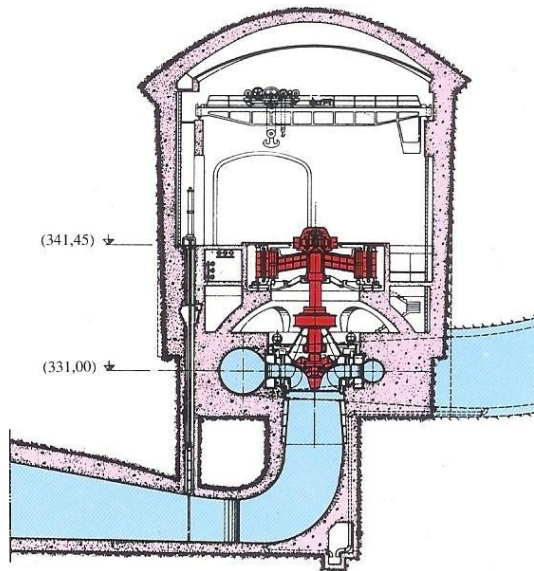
Corte transversal da central hidroeléctrica de aproveitamento de Bemposta; [3]
